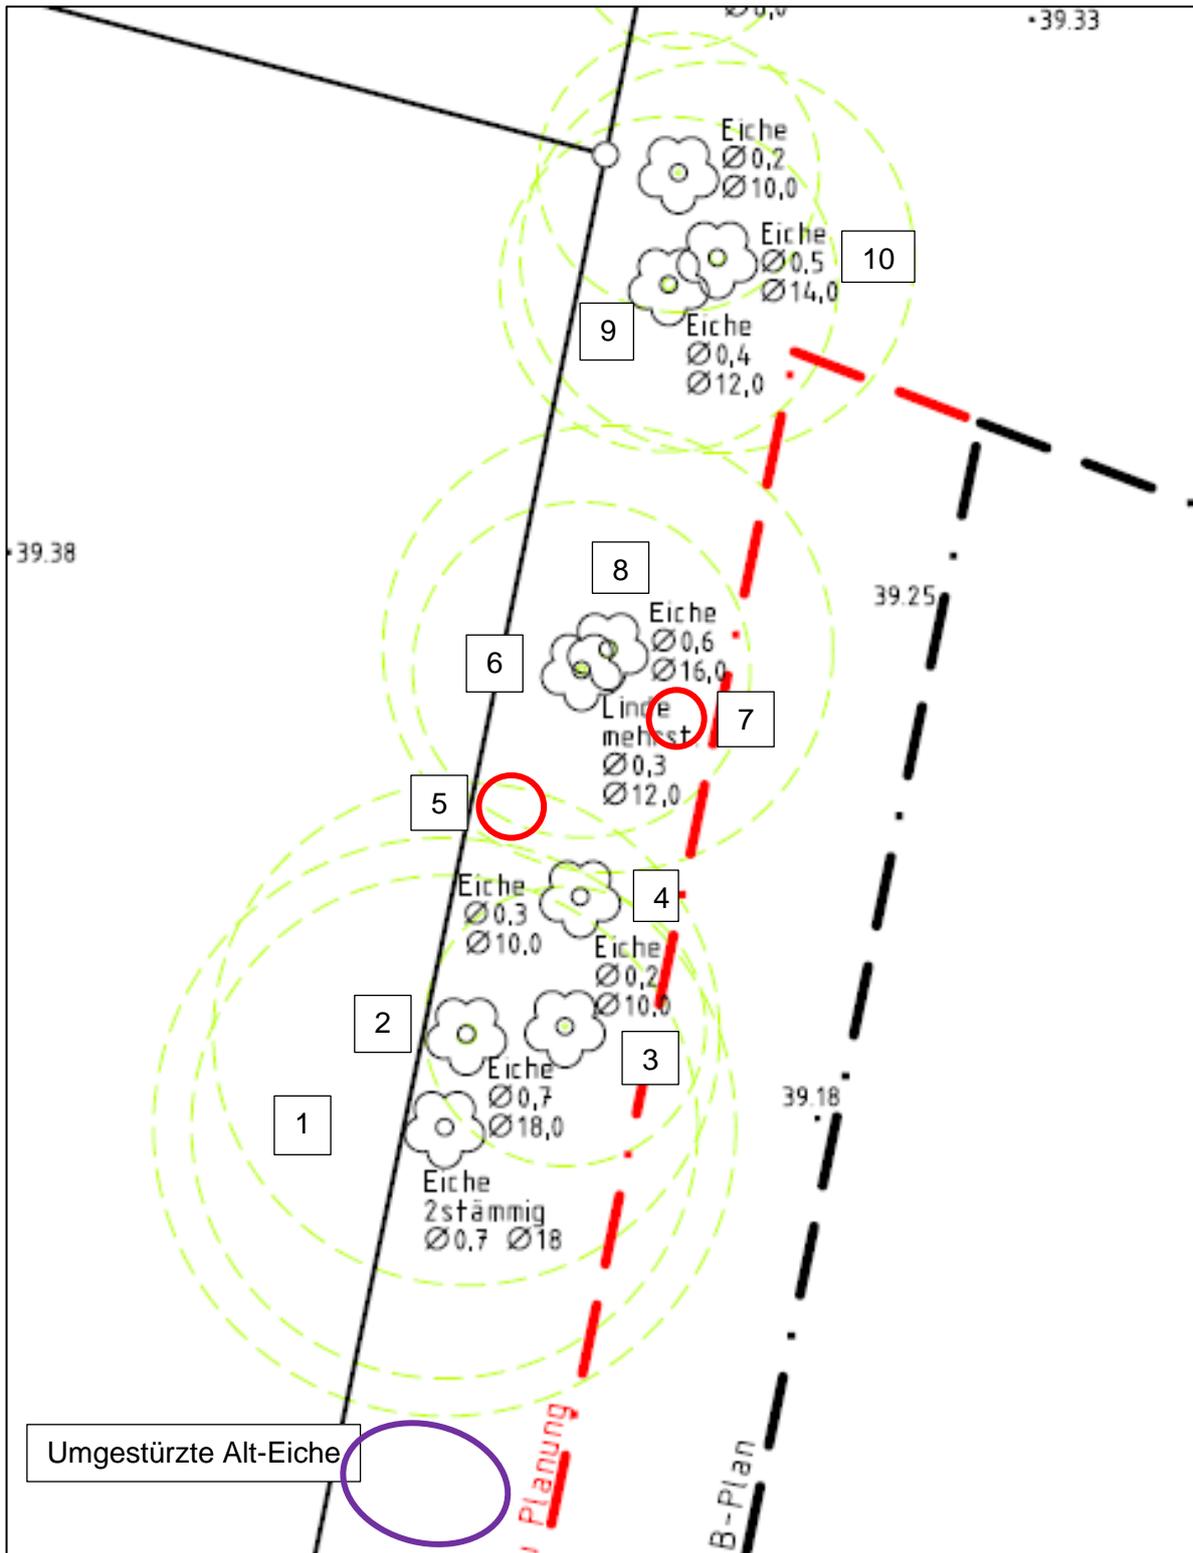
Ausschnitt Vermesserplan mit Baumnummern
